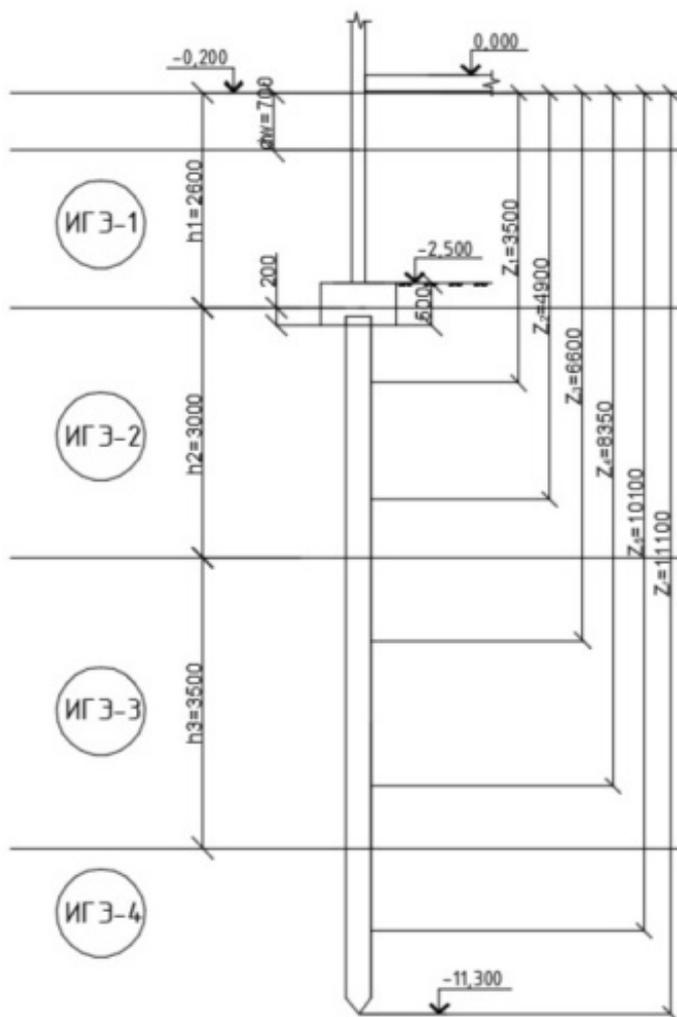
Расчетная схема свайного фундамента по несущей способности
